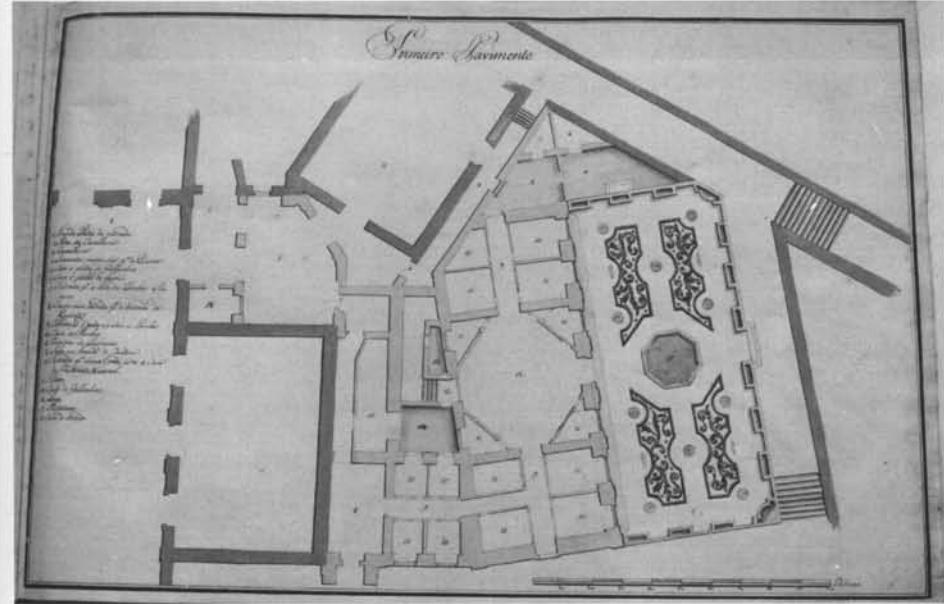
2.º Projecto: "8. Primeiro pavimento".
